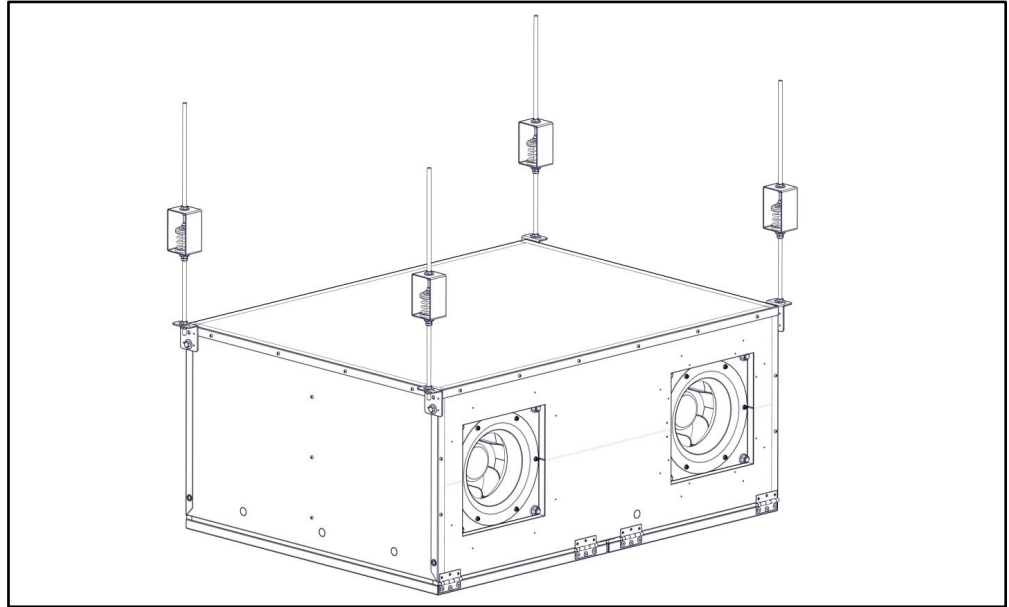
SUSPENSION AU PLAFOND AVEC LES PORTES D'ACCÈS VERS LE BAS
